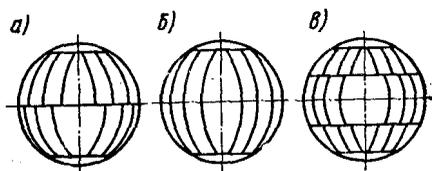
Схемы раскроя корпусов сферических резервуаров
